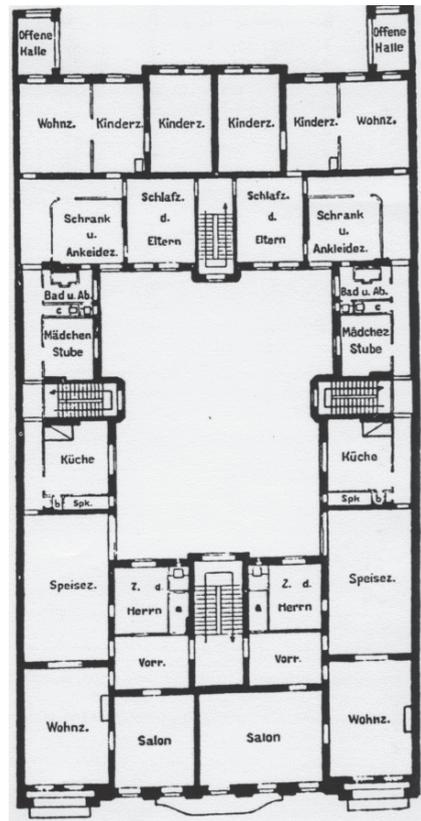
Grundriss zweier Etagenwohnungen
